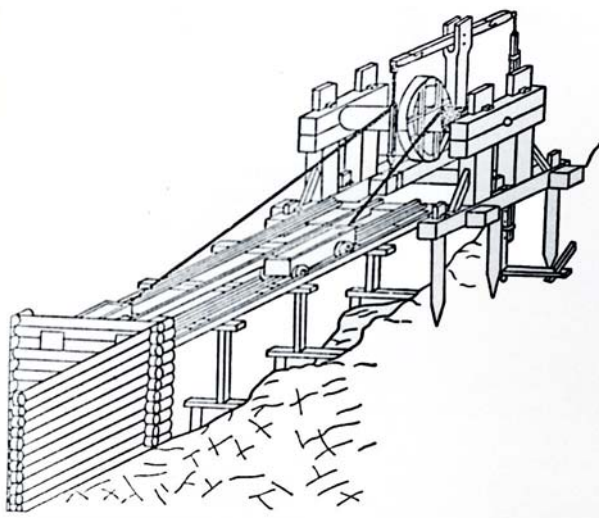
Plano inclinado de Chagirske con carriles de sección acanalada (1752). (Archivo RENFE).
